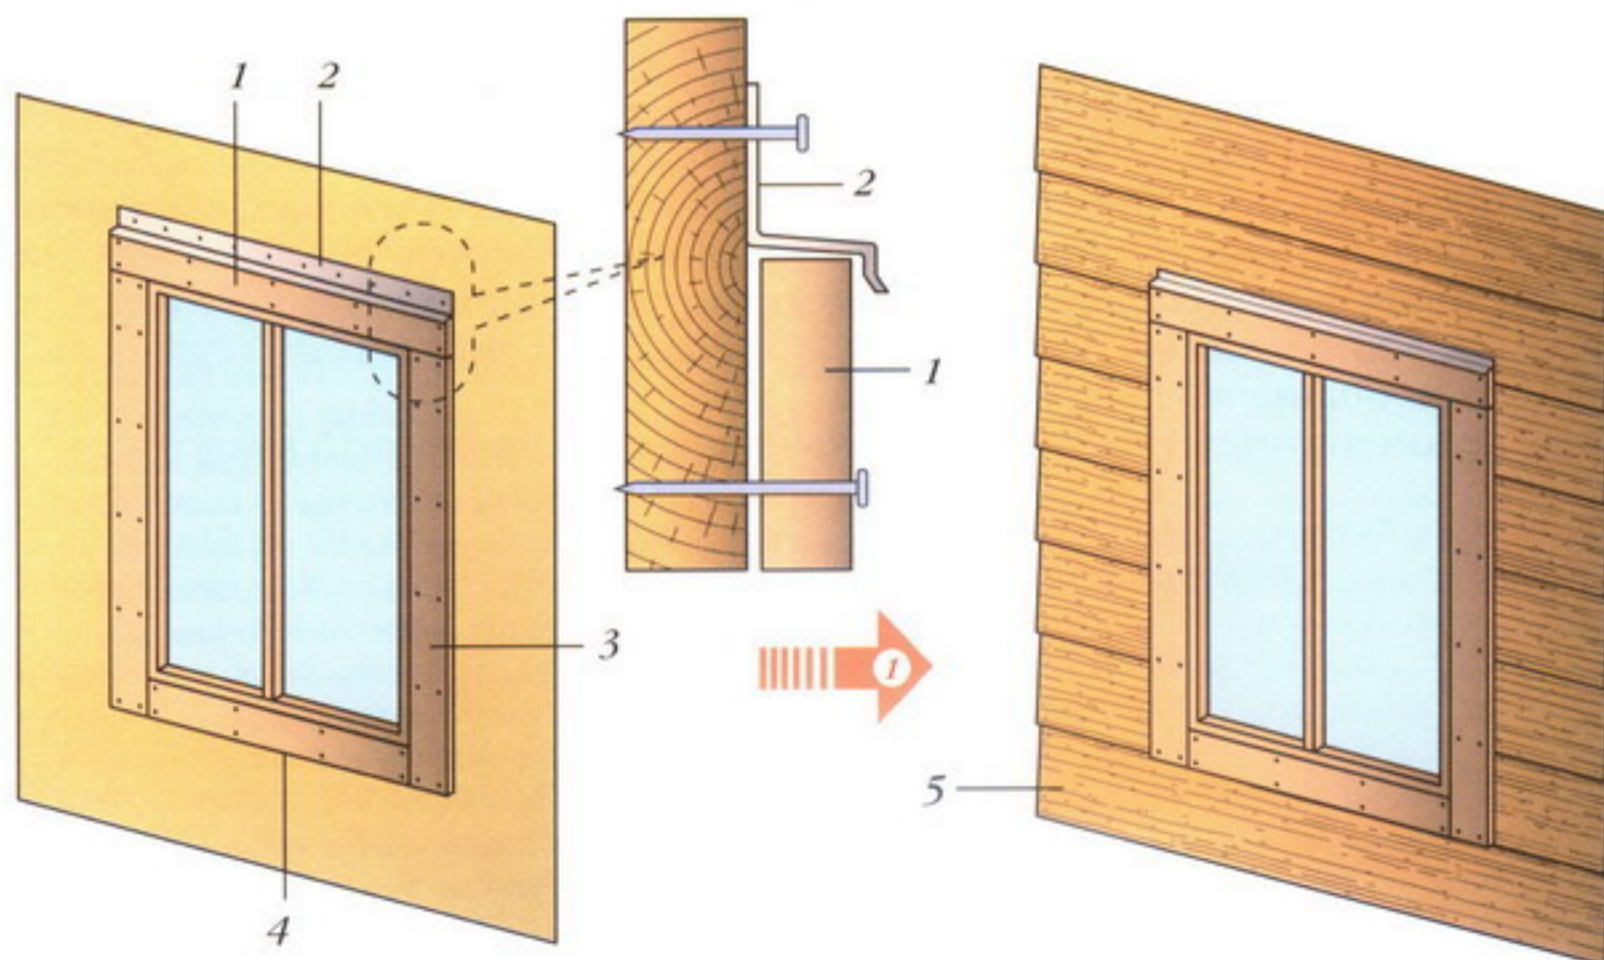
Монтаж погонажного сайдинга вокруг проемов: 1 — верхняя обвязка; 2 — отлив из кровельной жести; 3 — боковая обвязка; 4 — нижняя обвязка; 5 — рядовой сайдинг
